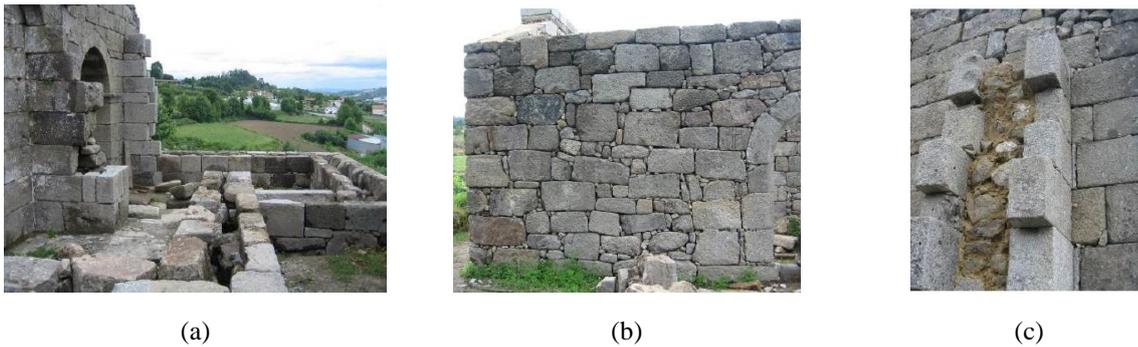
Igreja de São Cristóvão depois da intervenção: (a) Vestígios da capela-mor e sacristia; (b) Fachada lateral Sul; (c) Consolidação do arranque da parede da capela-mor do lado Norte [68]
